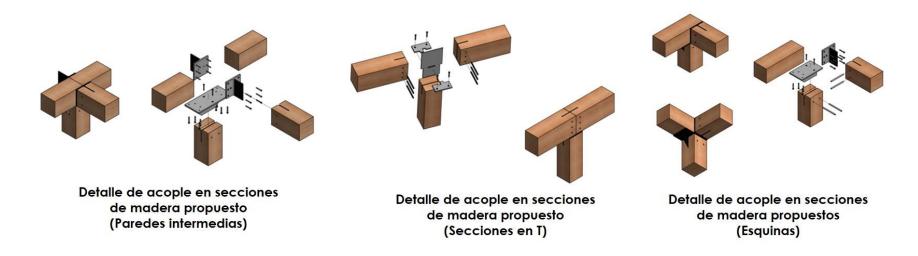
Detalles de los acoples metálicos utilizados en los detalles de madera. Fuente: Elaboración personal, 2020.
